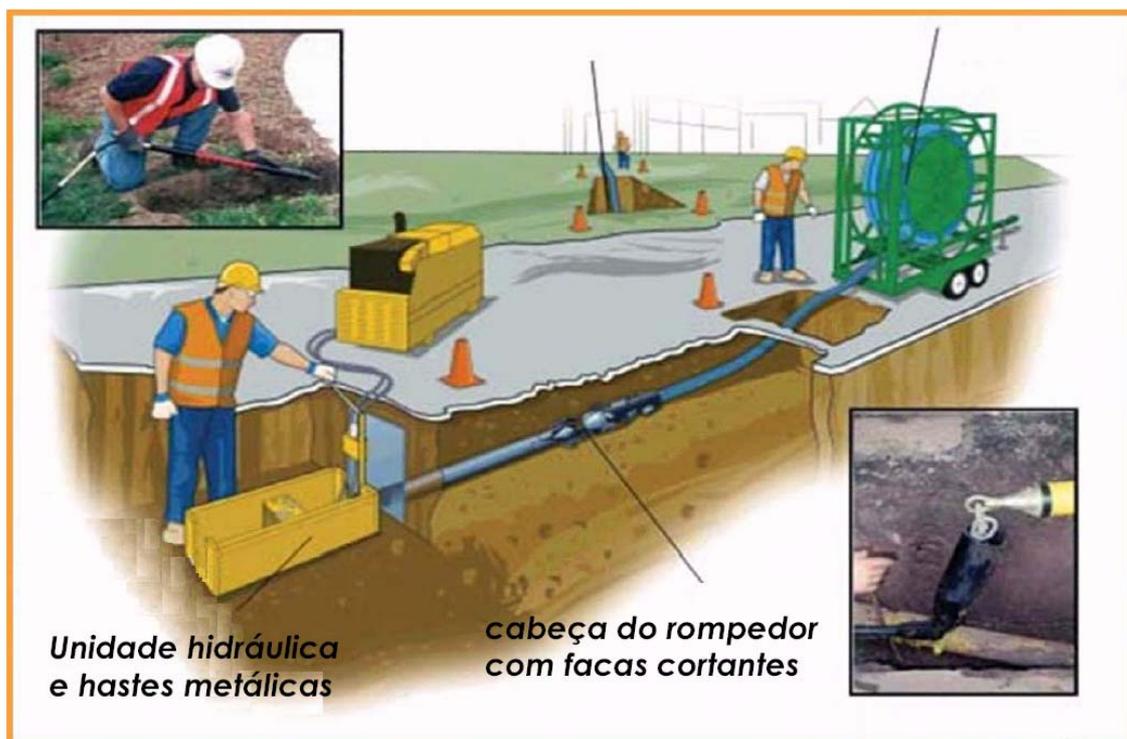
Processo de rompimento hidráulico ou estático (*pipecracking*)
